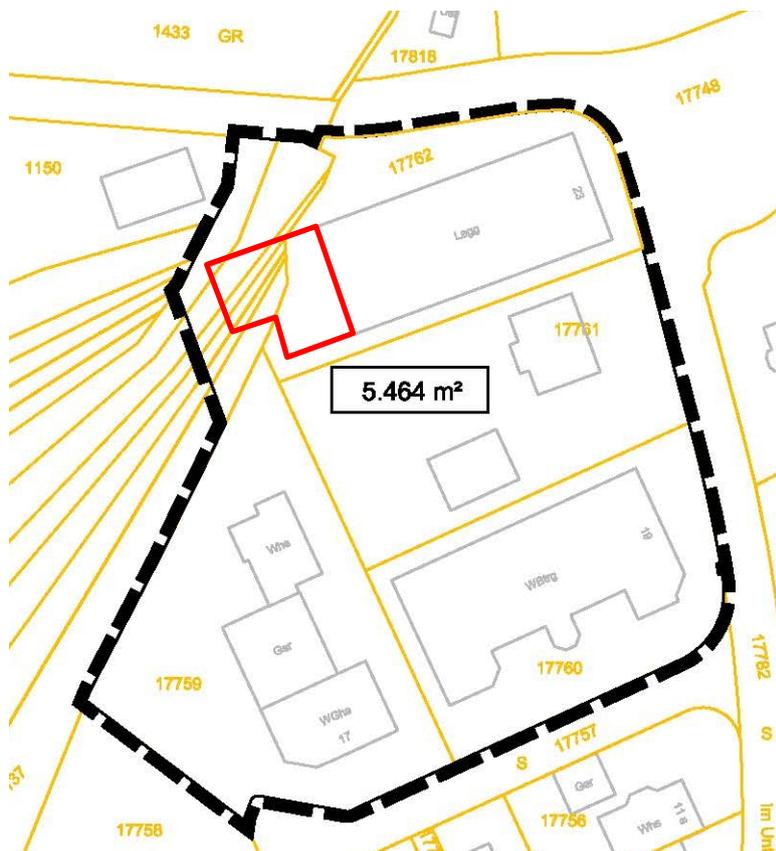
Bebauungsplan "Am Markbach", die geplante Hallenerweiterung ist rot markiert
